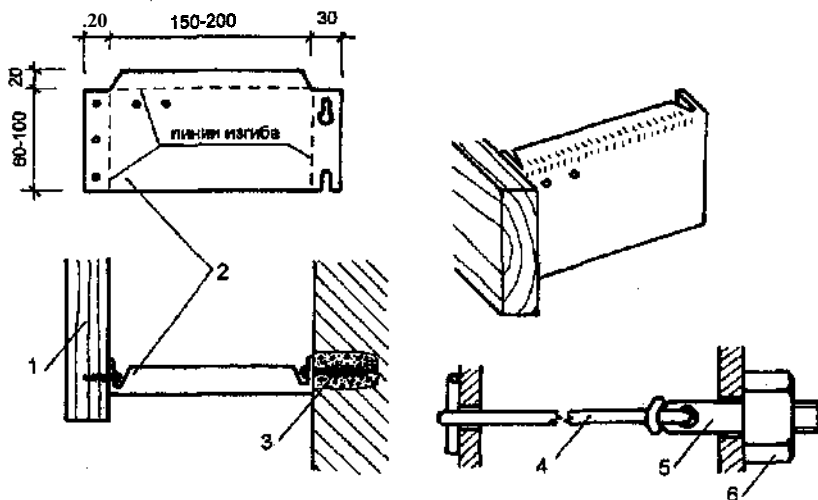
Оконный карниз: 1 — доска; 2 — металлический кронштейн; 3 — шуруп, закрепленный омоноличиванием; 4 — струпа; 5 — стальной вит; 6 — гайка
